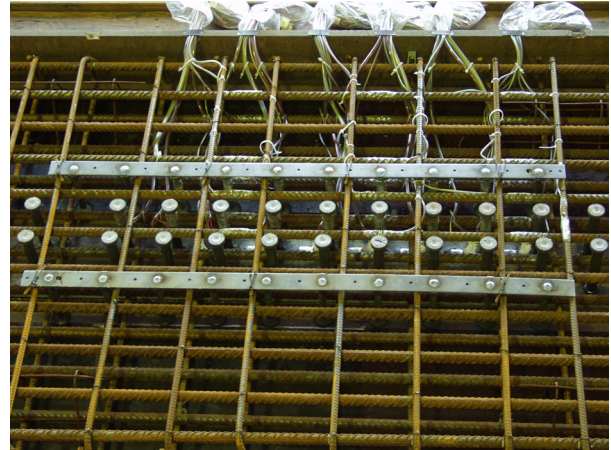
Träger T3 vor dem Betonieren, Detail der Dübelleisten
